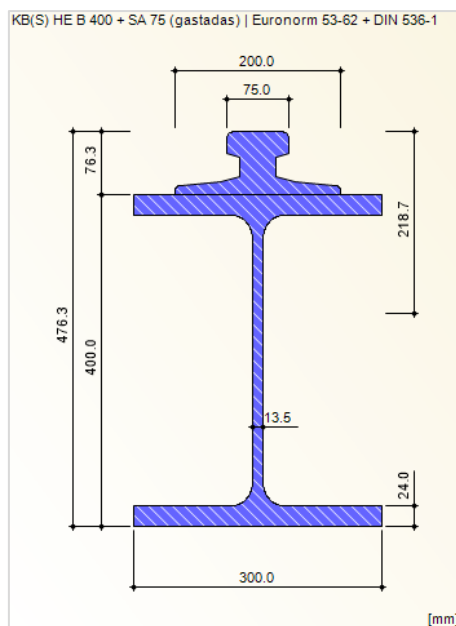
Sección de la viga carril (Perfil HEB 400+ Carril SA-75)
